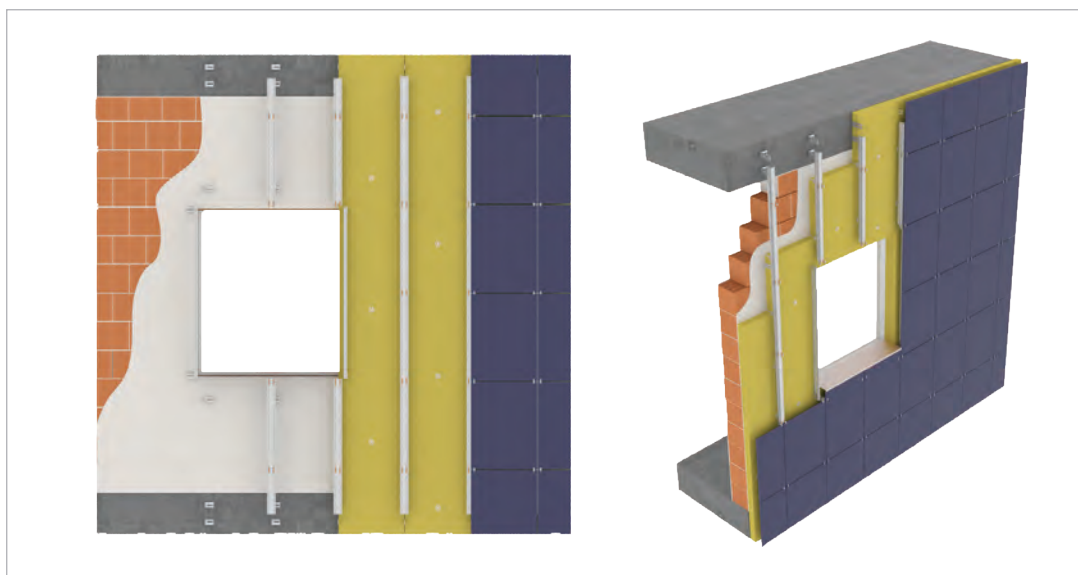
Vista frontale e spaccato assonometrico di un rivestimento a parete ventilata con sottostruttura a montanti in lega di alluminio e lastre rettangolari a basso spessore, fissate mediante clips a vista con montaggio a scatto
